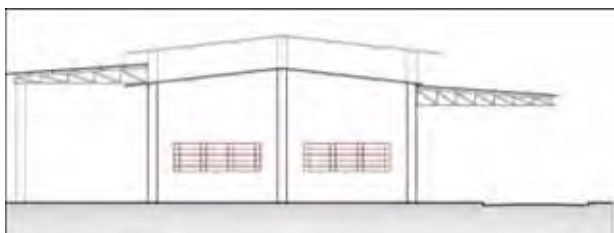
Planta do edifício que abrigará as oficinas de arte e sala de dança e ginástica. (Desenho da autora)
